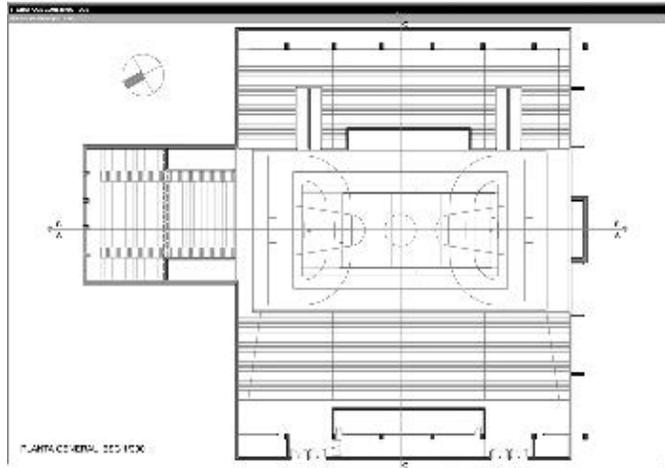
ELADIO DIESTE: PLANTA DEL GIMNASIO.
